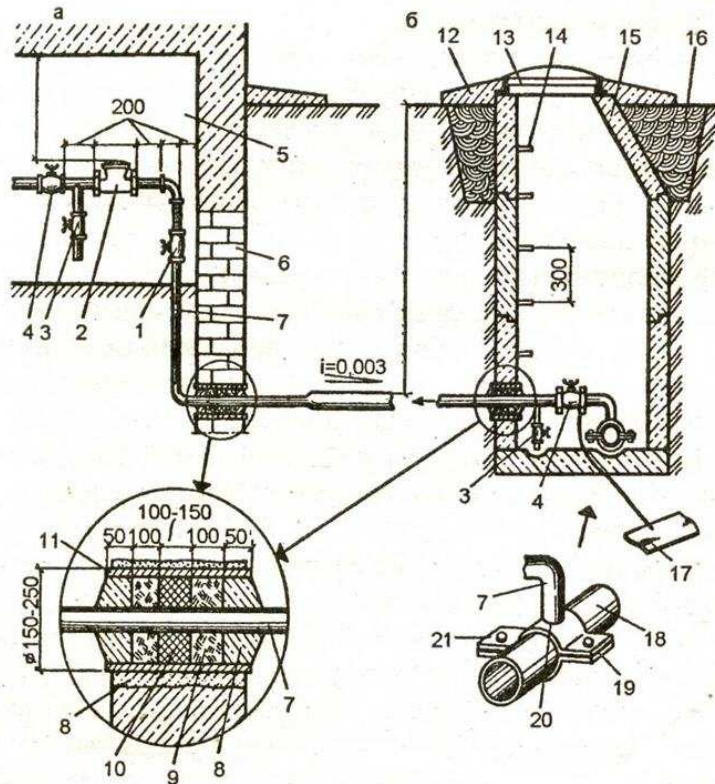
Влаштування водопровідного вводу та водозабірний колодязь: а - ввід через фундамент; б - водорозбірний колодязь; 1 - вхідний вентиль; 2 - водомір; 3 - зливний кран; 4 - перекривний вентиль; 5 - напіввідвал (підвал); 6 - фундамент; 7 - трубопровід вводу; 8 - цементний розчин; 9 - смоляне пасмо; 10 - м'ята глина; 11 - футляр (чавунна або керамічна труба); 12 - вимоцнення; 13 - люк; 14 - хо дові скоби; 15 - фасонне бетонне кільце; 16 - глиняний замок; 17 - заземлення; 18 - труба вуличного водопроводу; 19 - гумова прокладка; 20 - зварювання; 21 - хомут.
